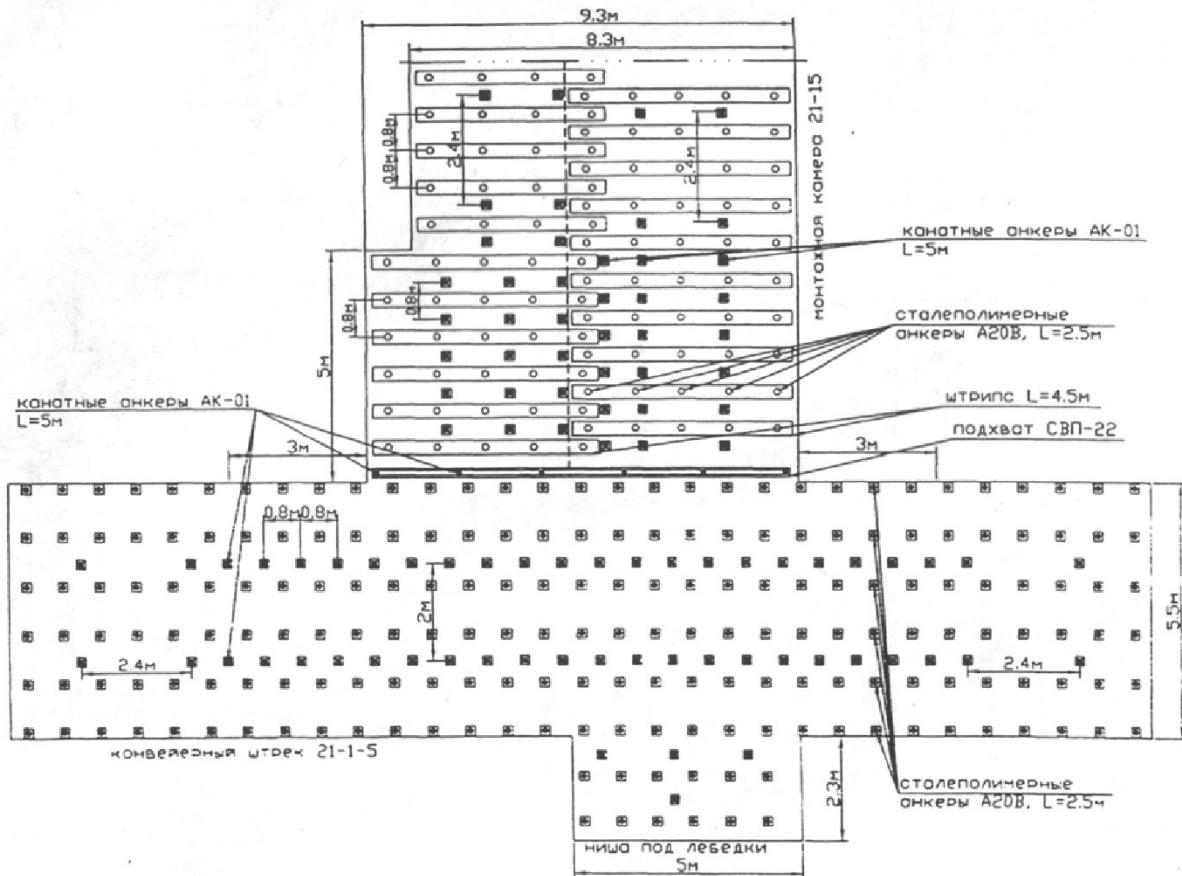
Схема крепления сопряжения монтажной камеры 21-1-5 с конвейерным штреком 21-1-5
